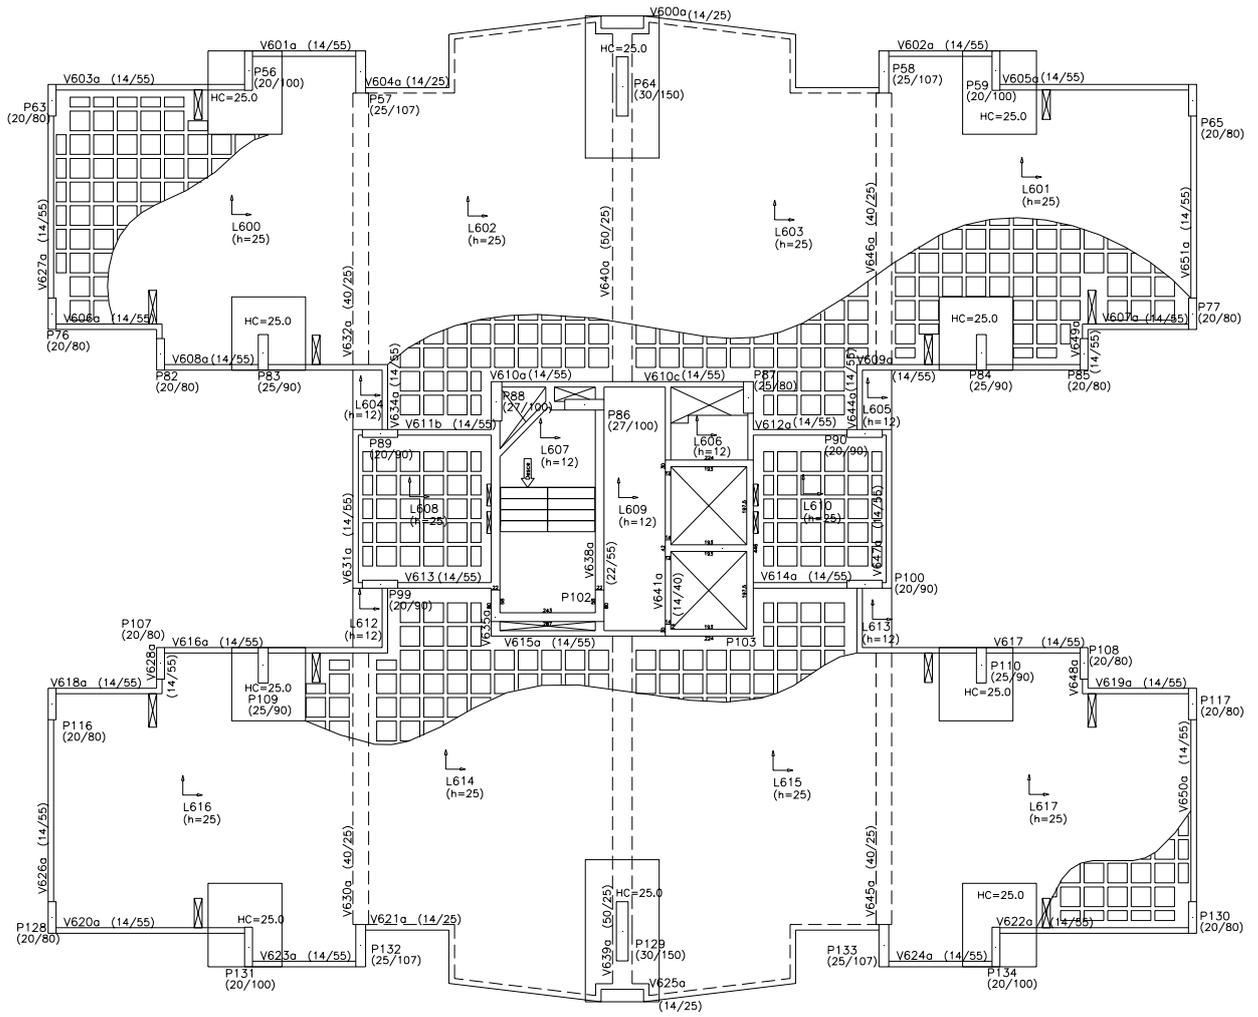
Planta baixa do pavimento tipo do Edifício 04
